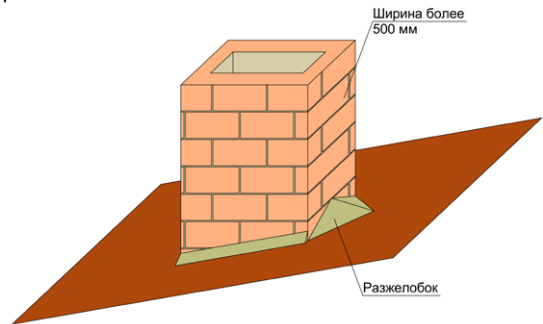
Примыкание кровли к трубе дымохода шириной более 500 мм.
